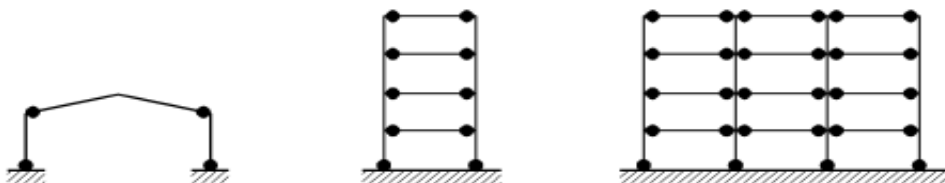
Ossatures en portique (zones dissipatives dans les poutres et en pied de poteaux). [5]
